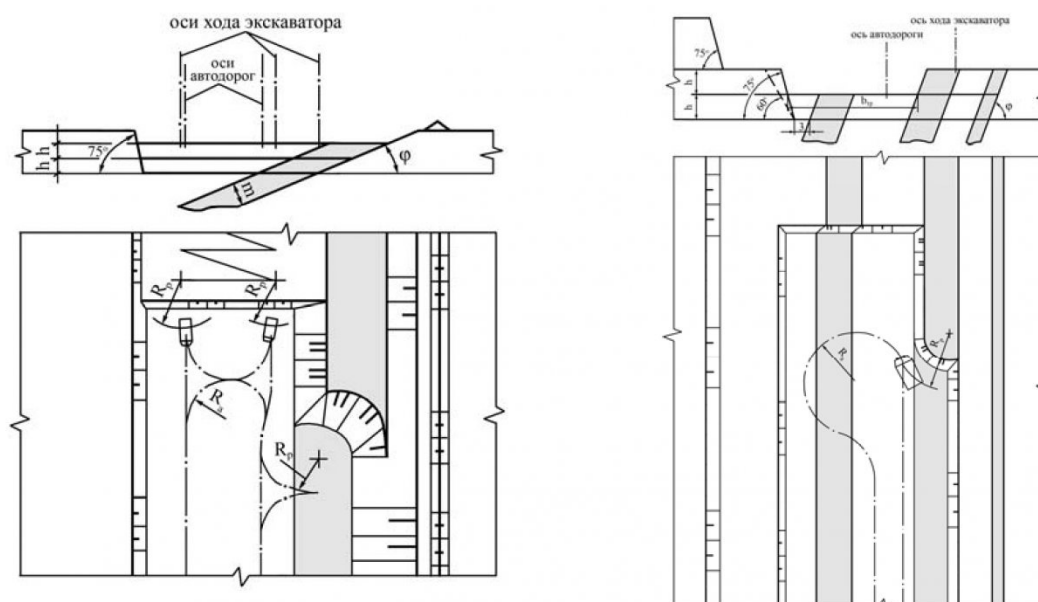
Схемы разработки: а – наклонного пласта (20-45°) при трехслойной разработке уступа; б – свиты крутых пластов (46-90°) при двухслойной разработке уступа.
